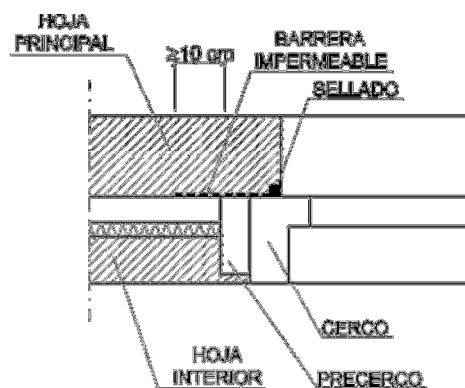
Ejemplo de encuentro de la fachada con la carpintería
